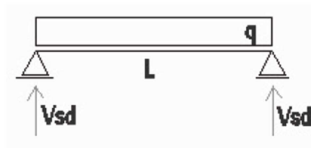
Viga V2AM da Elevação 3000 a 9000
